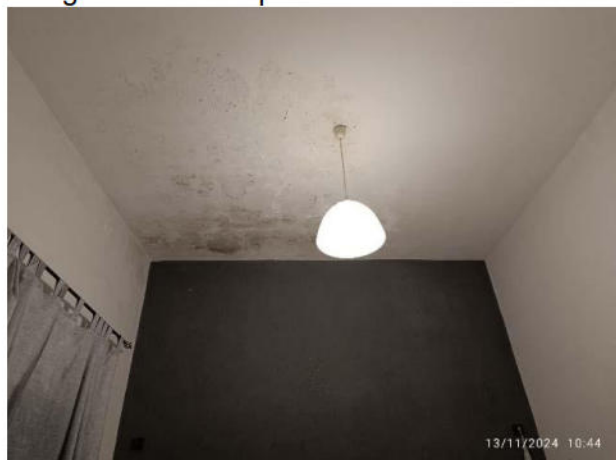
Macchie di umidità discendente nelle camere 6 e 4 dovute a guasti nell'impermeabilizzazione di copertura
